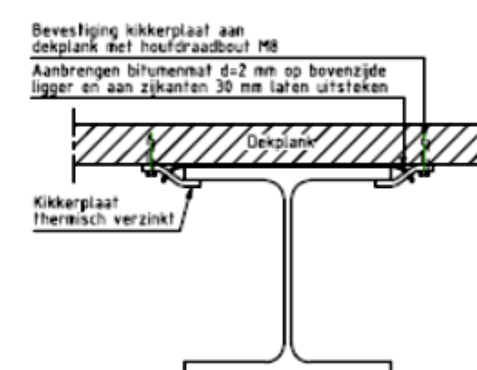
Detail A - Bevestiging dek aan stalen liggers bij geheel vervangen van het dek
